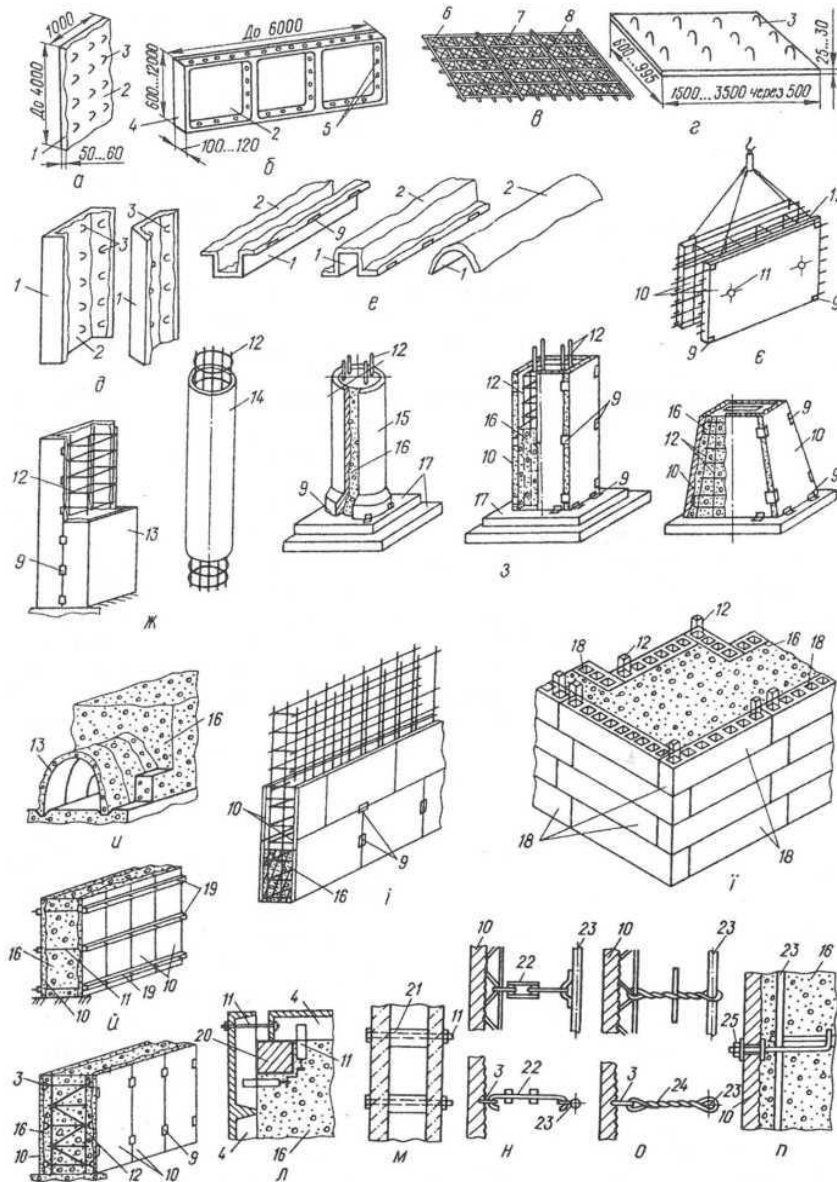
Незнімна опалубка: *а, б* — залізобетонна плоска та ребриста опалубка; *в* - армопакет армоцементної опалубки; *г* - армоцементна опалубка; *д, е* - профільні елементи опалубки; *е* - арматурно- опалубний блок; *ж* - опалубка колон; *з* - опалубка фундаментів під колони; *и* - опалубка каналу в масивному фундаменті; *і* - опалубка стіни; *і* - опалубка масивного фундаменту під устаткування з уніфікованих дірчастих блоків; *й* - кріплення опалубки неармованих конструкцій із застосуванням інвентарного зовнішнього каркаса; *к
